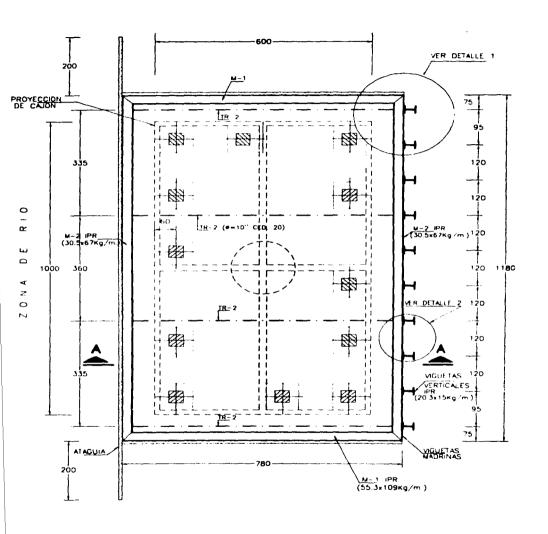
30 DETALLES DE EXCAVACION Y TROQUELAMIENTO DEL CAJON TIPO II
